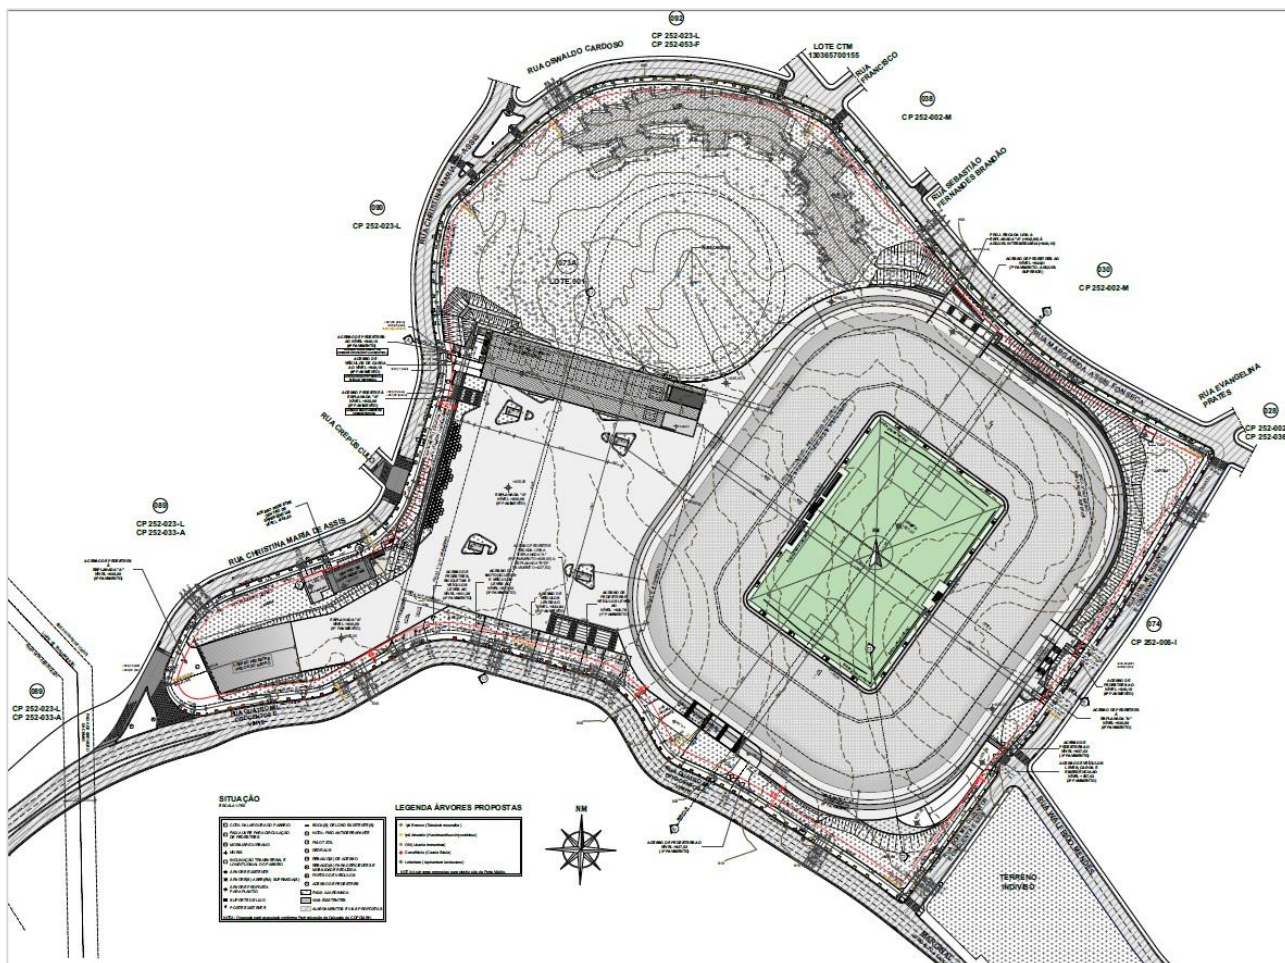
Recorte da planta de situação do empreendimento. Fonte: Prancha Projeto arquitetônico, Farkasvölgyi & Arquitetos Associados Ltda, 2025.
